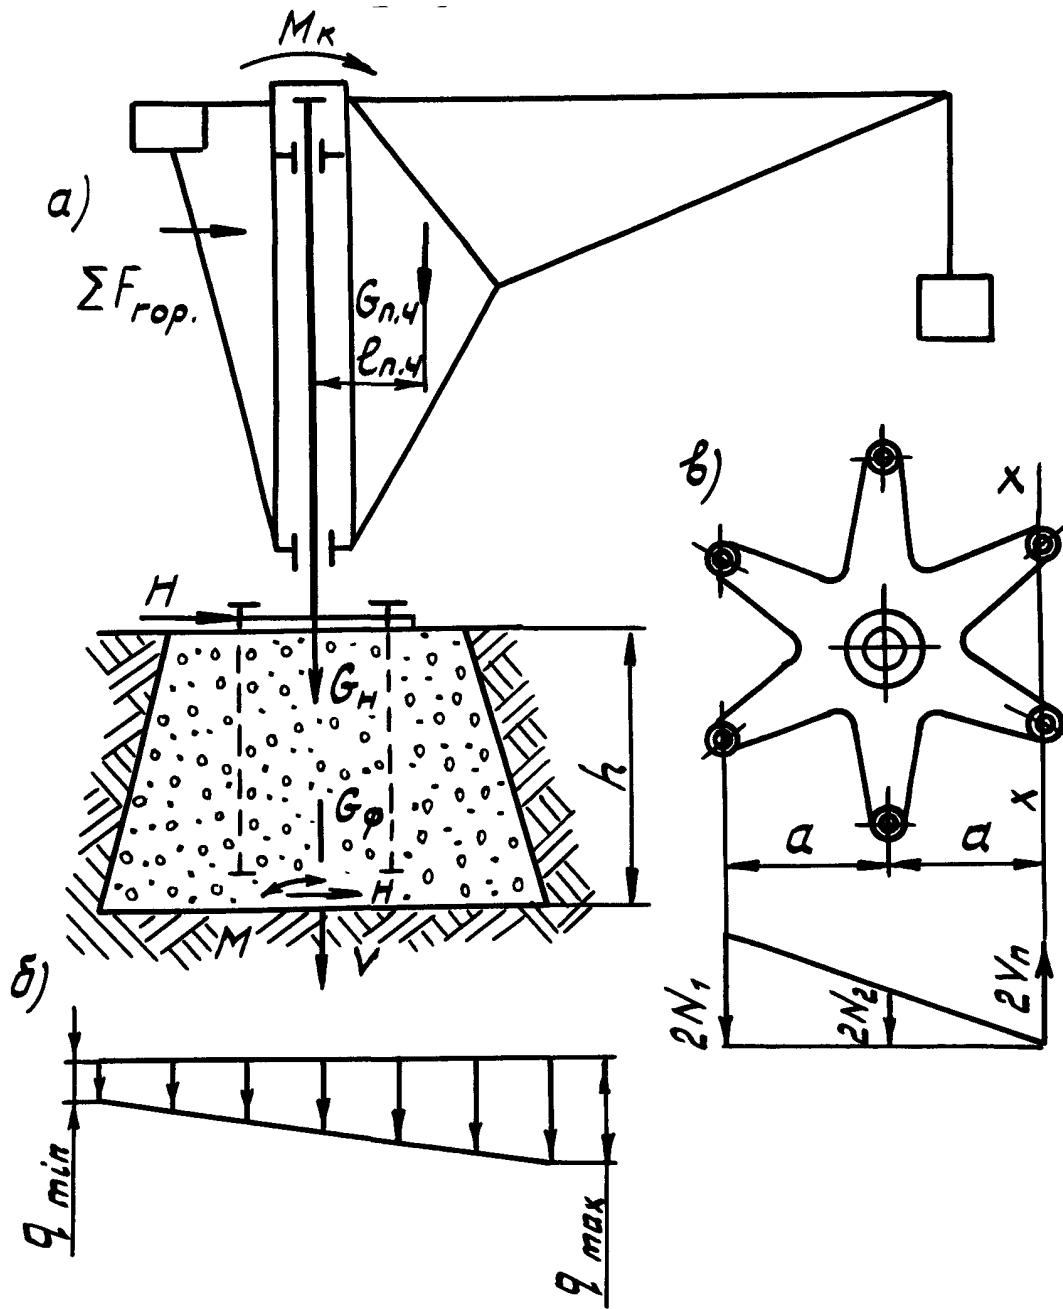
Расчетные схемы фундамента (а) с эпюрой давления на грунт (б) и фундаментной плиты (в)
